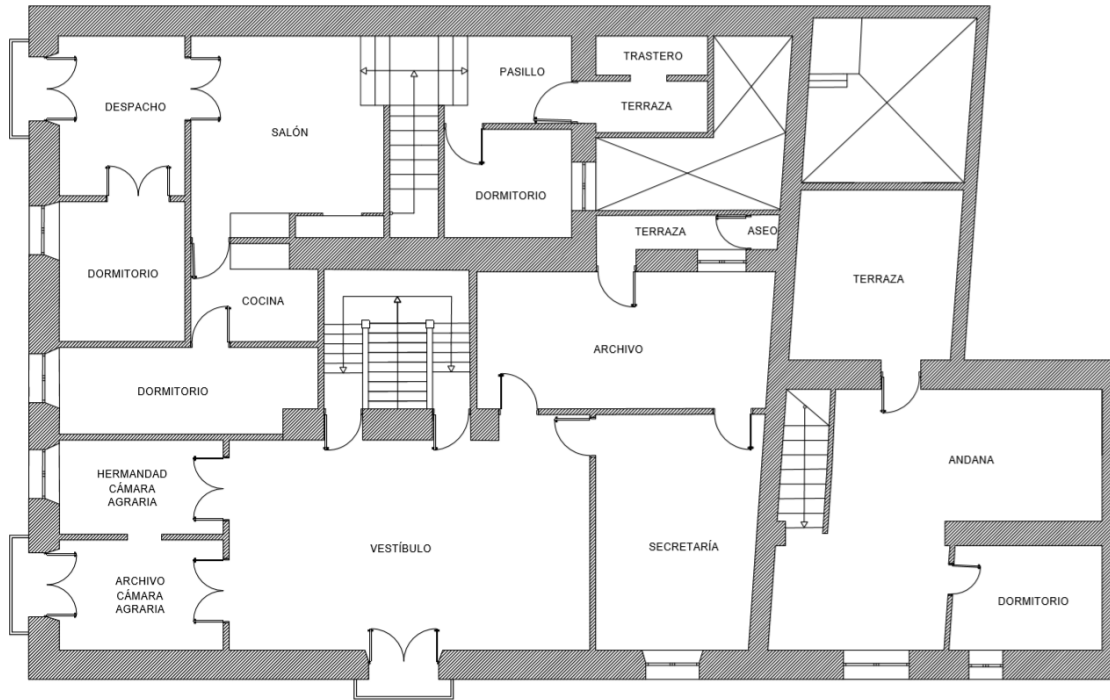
Plano planta primera, anterior a 1984. Fuente: elaboración propia, creación 20/06/2019
